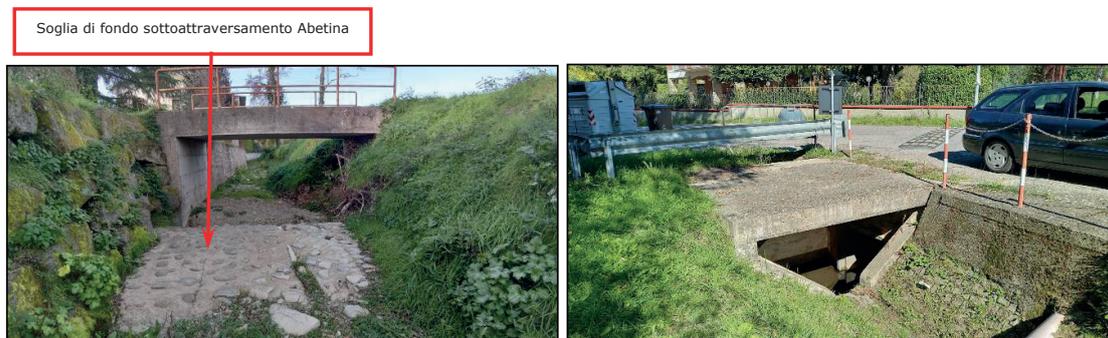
Vingone alveo in corrispondenza di sottoattraversamento Abetina VvV. Foto 12. Abetina pozzetto ingresso sottoattraversamento VvM.
